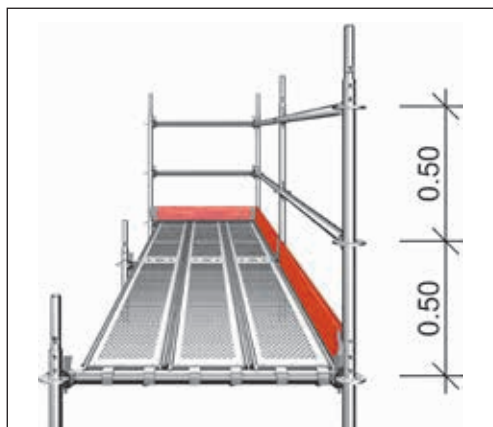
Detail van de montageleuning bij niveauwisseling
